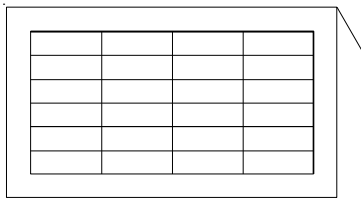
Bandartig, parallel und in Abstand zur Dachkante Neigung der Anlage entspricht der Dachneigung
